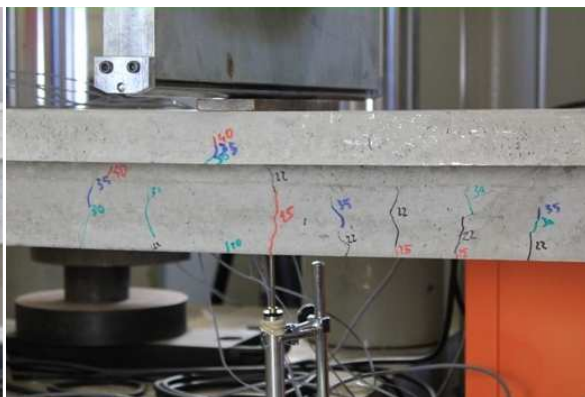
Padrão de fissuras no vão direito da viga G2-b para a carga de 40 kN
